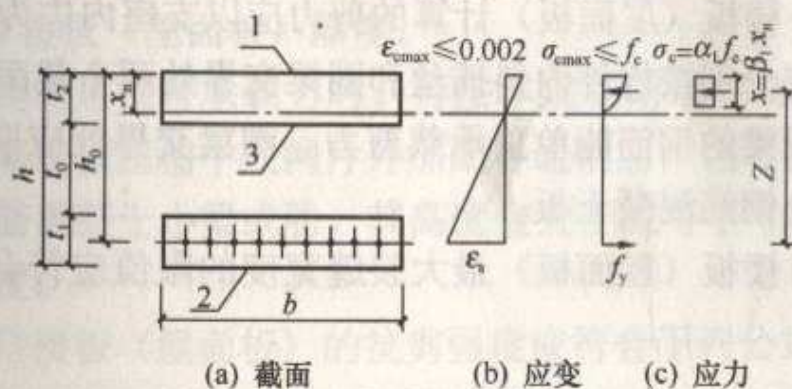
3D板混凝土构件正截面的混凝土和钢筋的应变与应力
